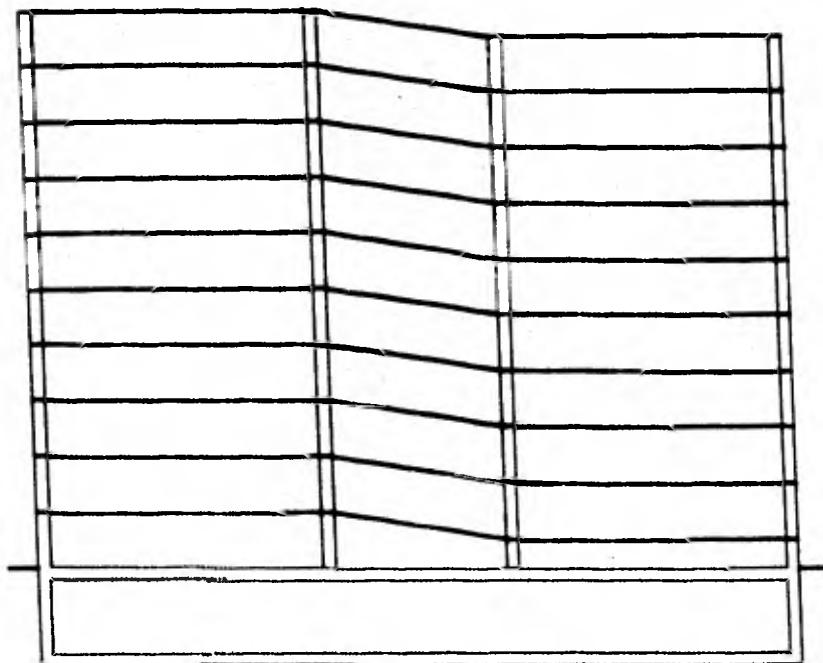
Corte esquemático transversal del edificio. Solución metálica.
